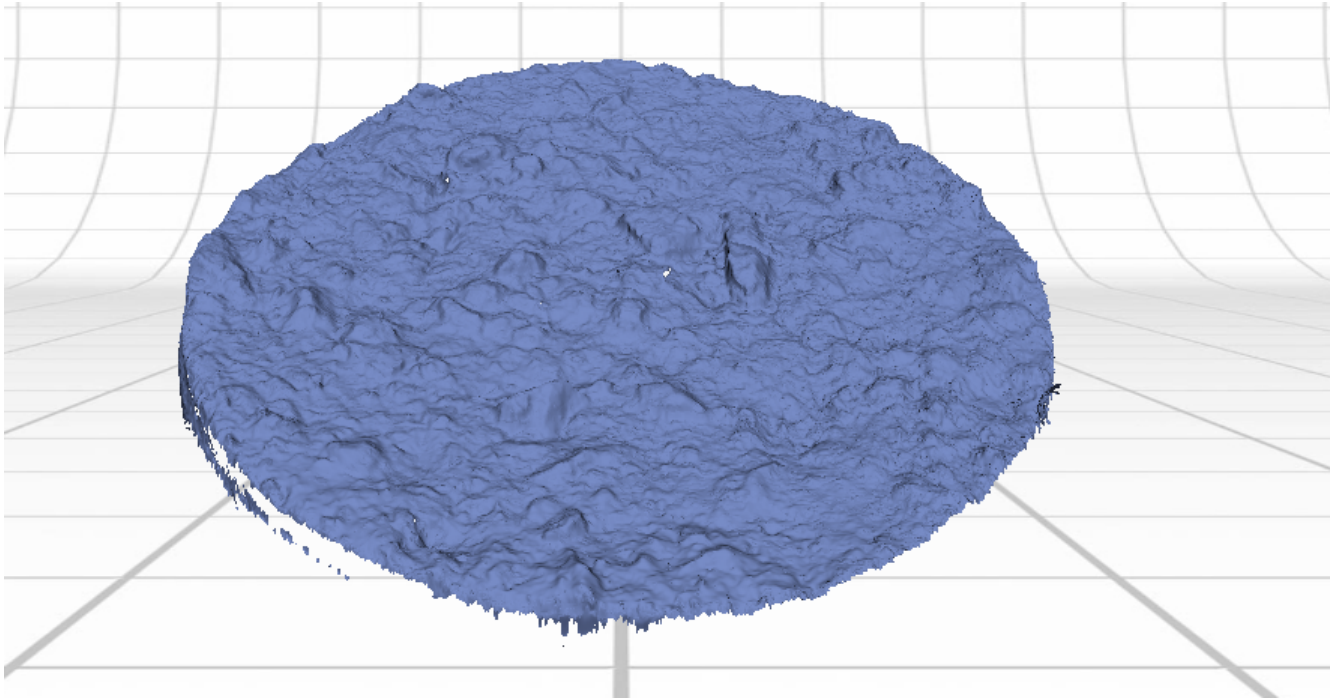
Perfilamento tridimensional com 6 leituras do Pavimento asfáltico 1.
